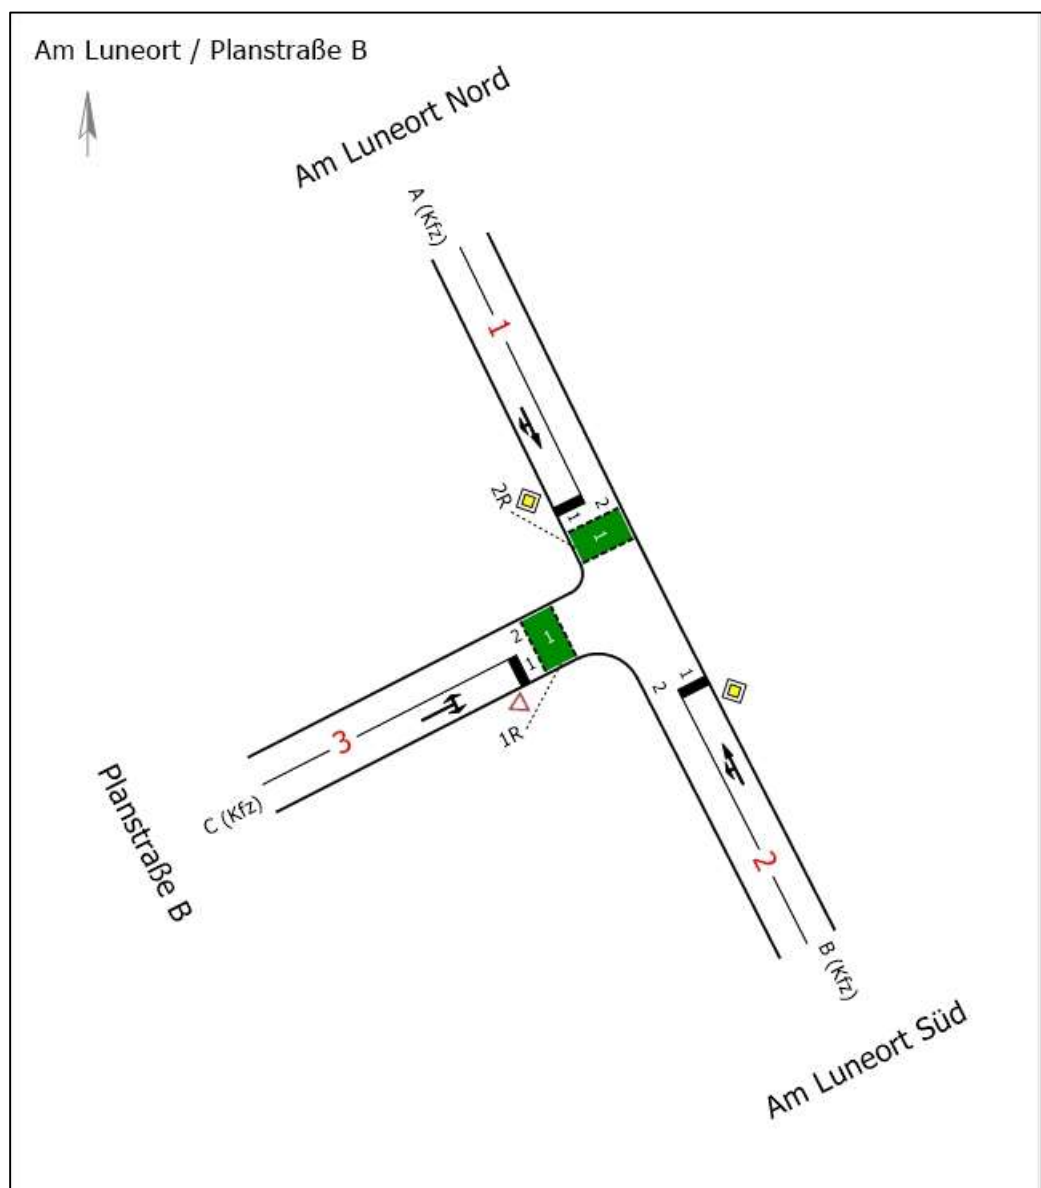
Signalplan „Am Luneort / Planstraße B“
